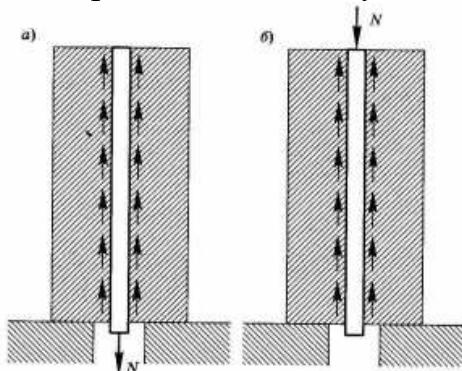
Схеми випробувань на порушення зчеплення арматури з бетоном:
